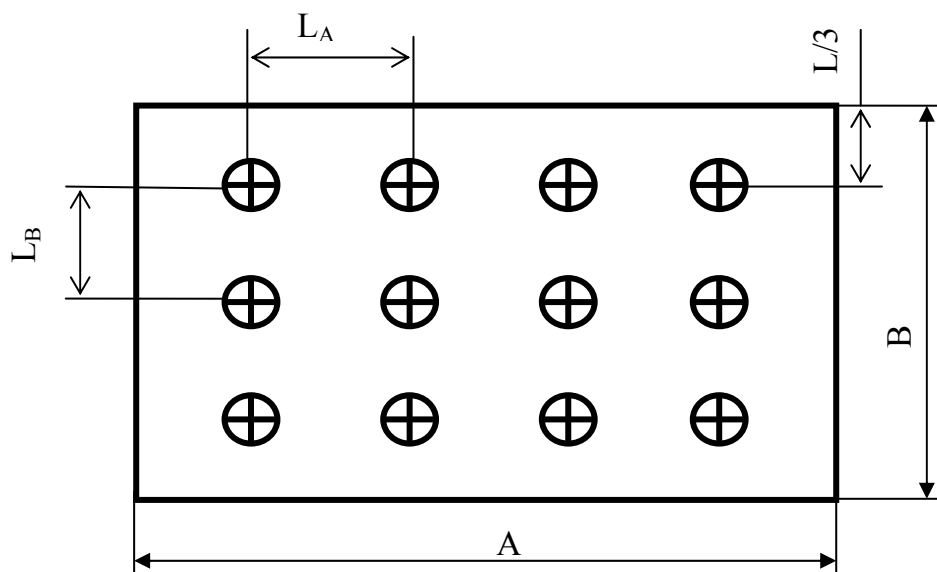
Схема размещения светильников в помещении для ламп накаливания
